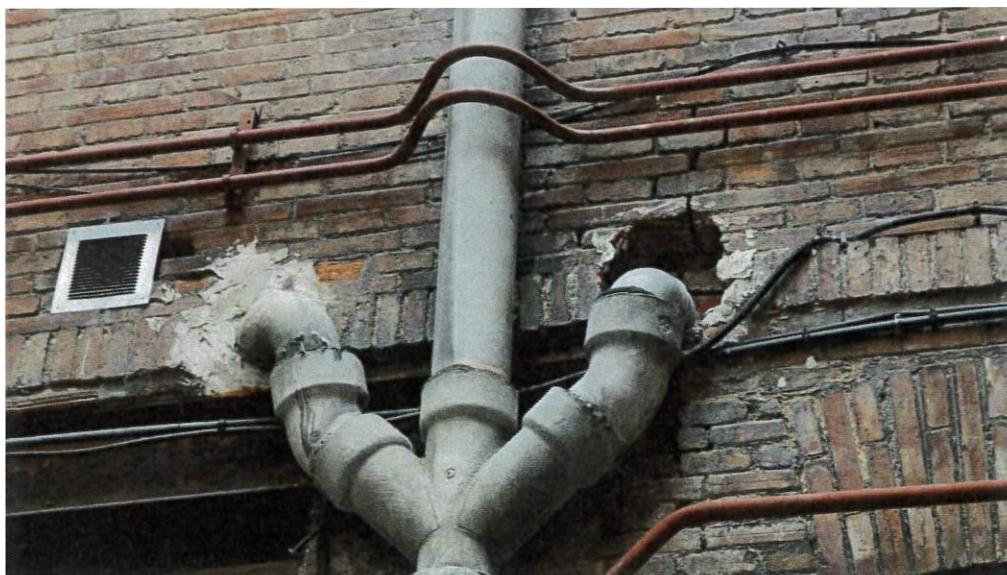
Fotografía de la alteración de la fachada por colocación de instalaciones
